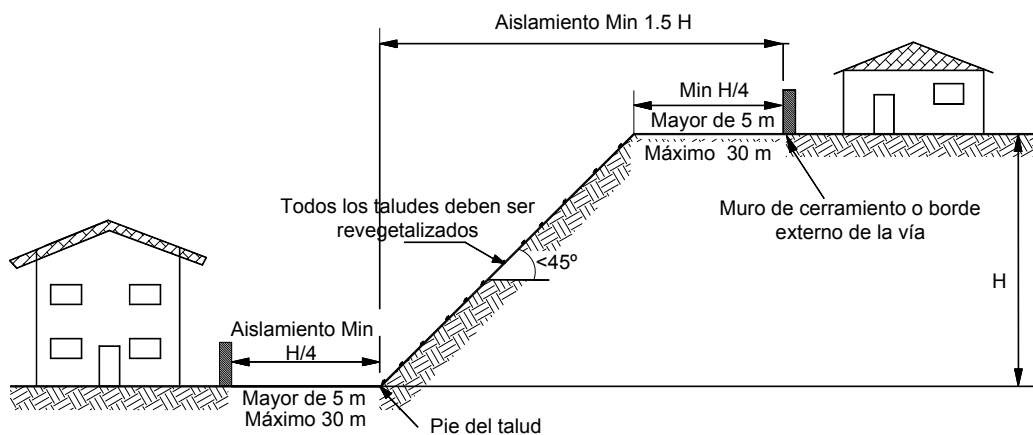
Aislamientos exigidos en el “Uniform Building Code” de los Estados Unidos (International Conference of Building Officials, 1991).
